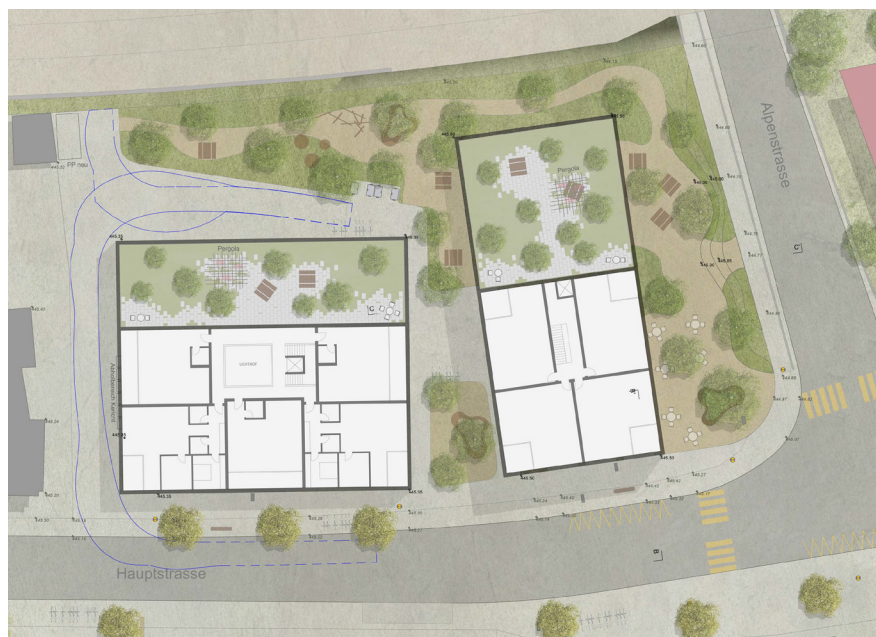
Situationsplan mit Aussenraumkonzept und Dachgärten (Quelle: SDM - ARCHITEKT und grünwerk 1 landschaftsarchitekten ag, Juni 2023)
